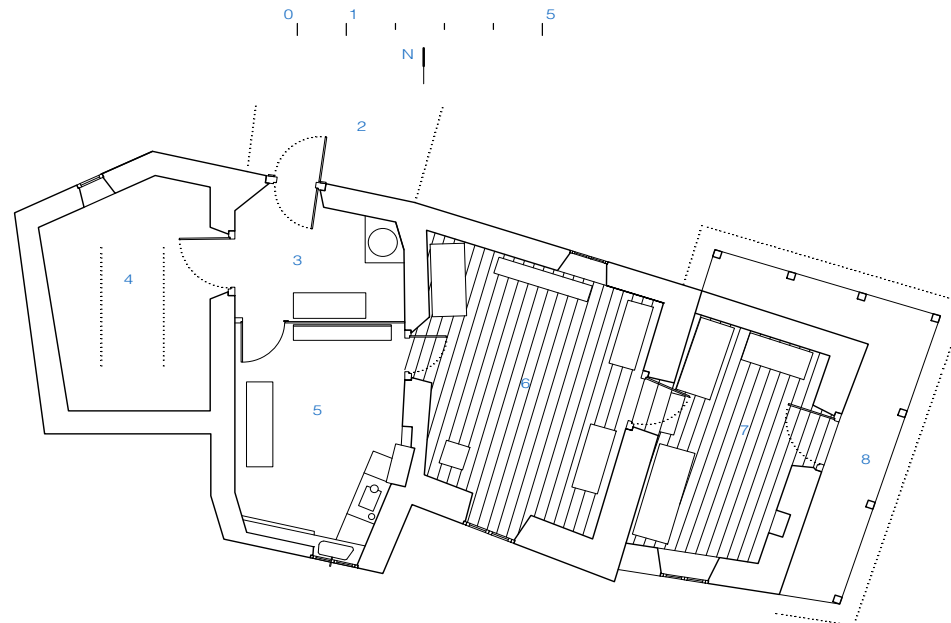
Plantas vivienda A Ferrería, O Incio.
